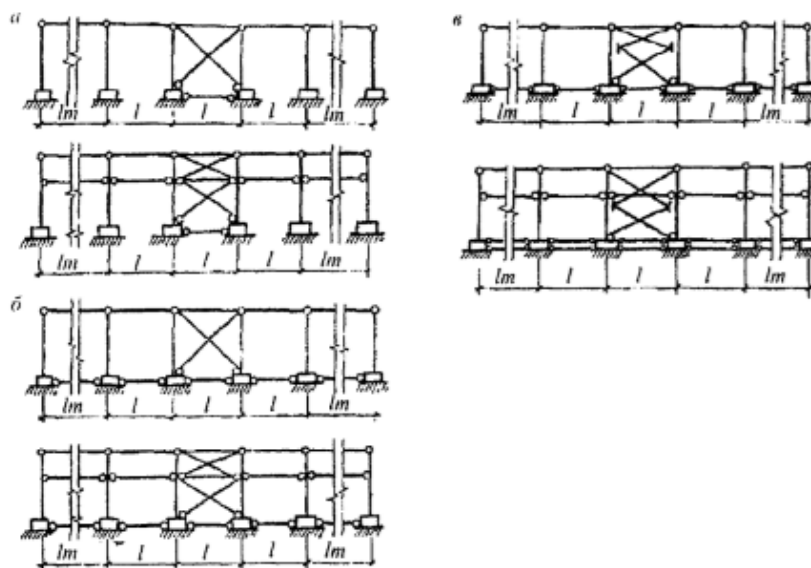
Схемы продольных рам одноэтажных каркасных зданий (с применением и без применения кранов)
